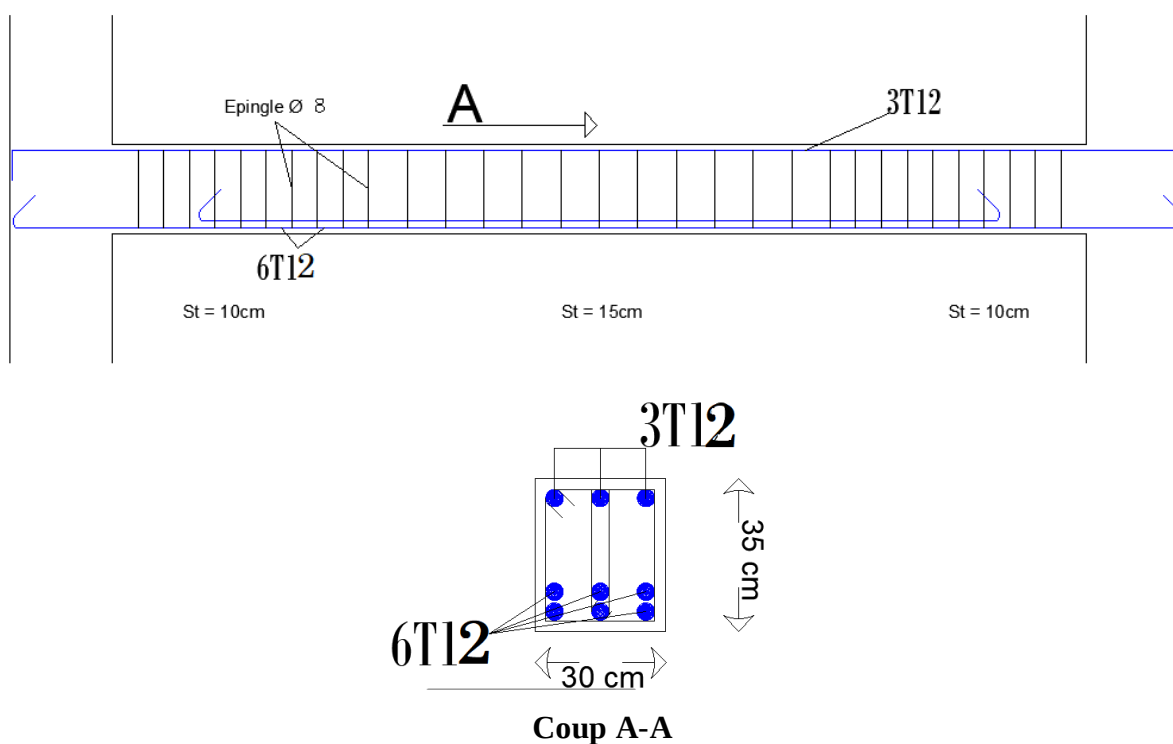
Schéma de ferrailage de la poutre palière (par autocad)
